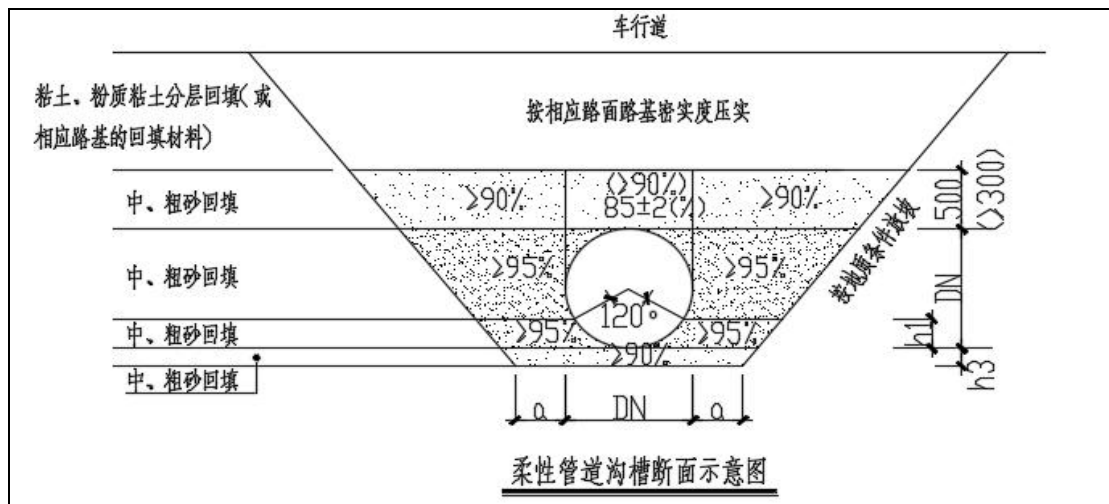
管道工程沟槽断面示意图 (车行道)
